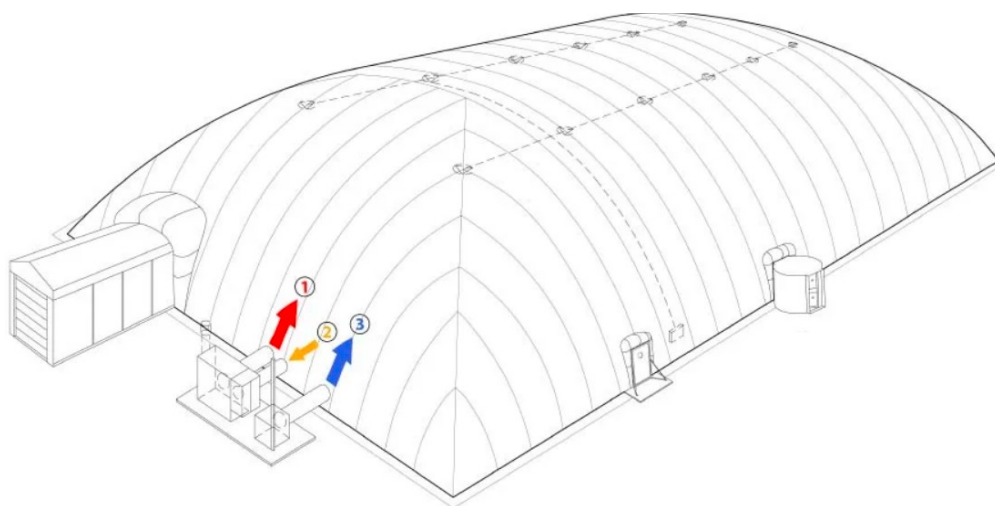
Вид воздухоопорной оболочки: 1- подача теплого воздуха; 2 - уменьшение избыточного давления; 3 - подача холодного воздуха
